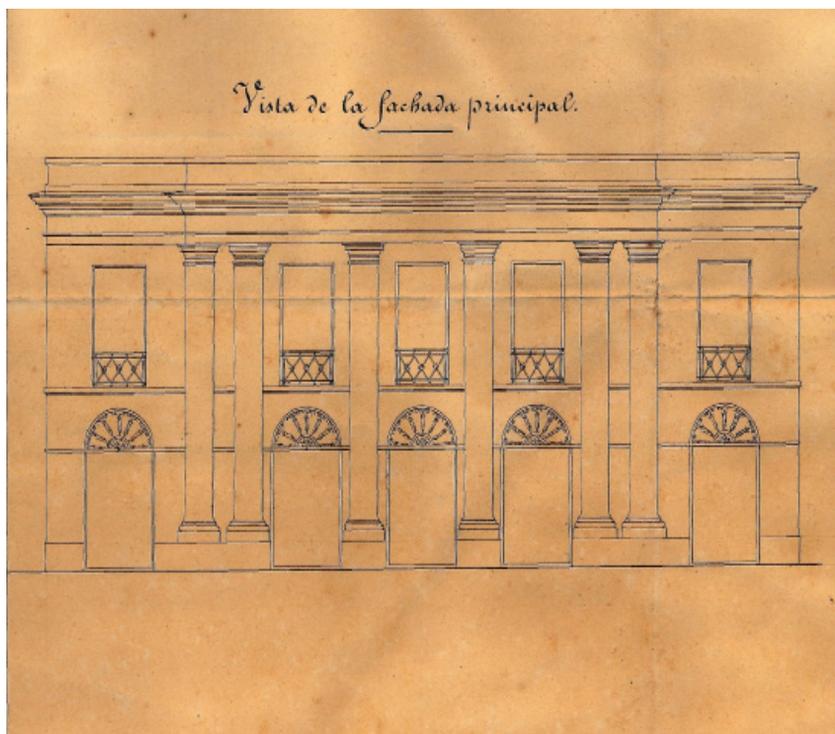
Detalle de la fachada (AHMM, Cuba 257/01)
